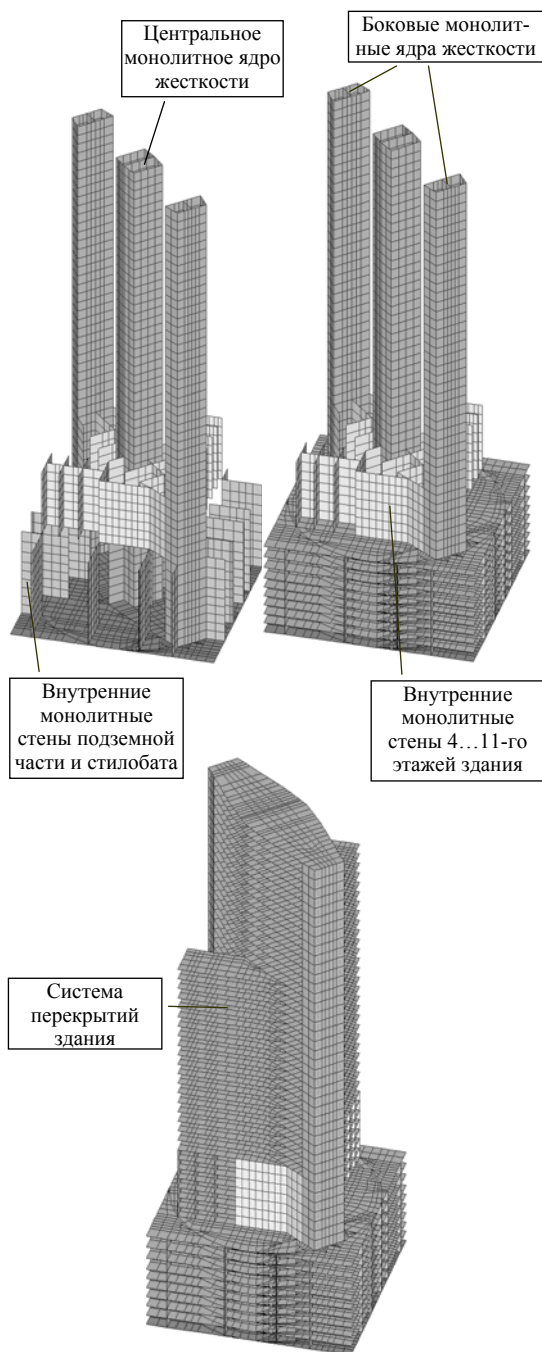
Конструктивная схема внутренних монолитных стен здания и перекрытий
